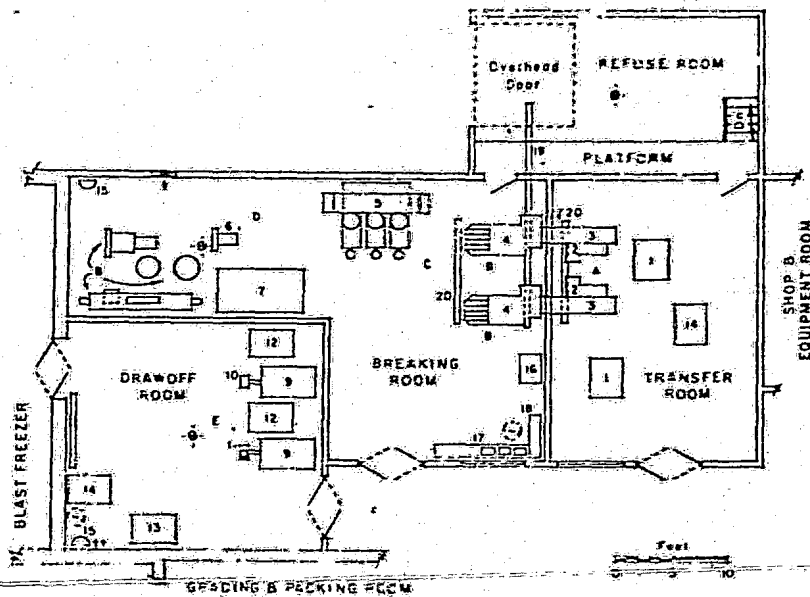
Plano del primer piso más detallado de una planta quebradora (Fig. 22).
